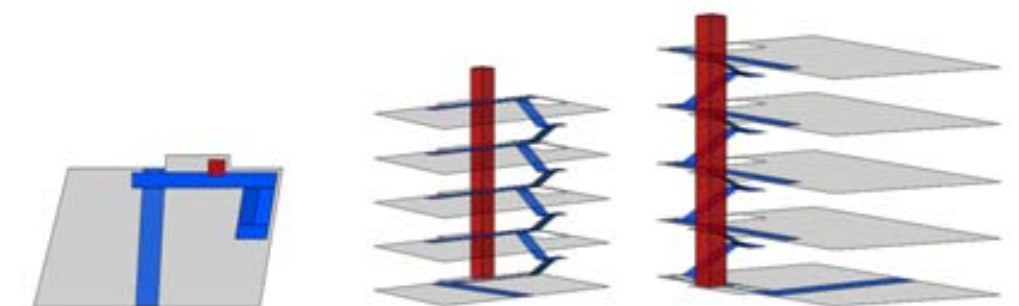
Erschließungsmodell Wallensteinstraße 31
